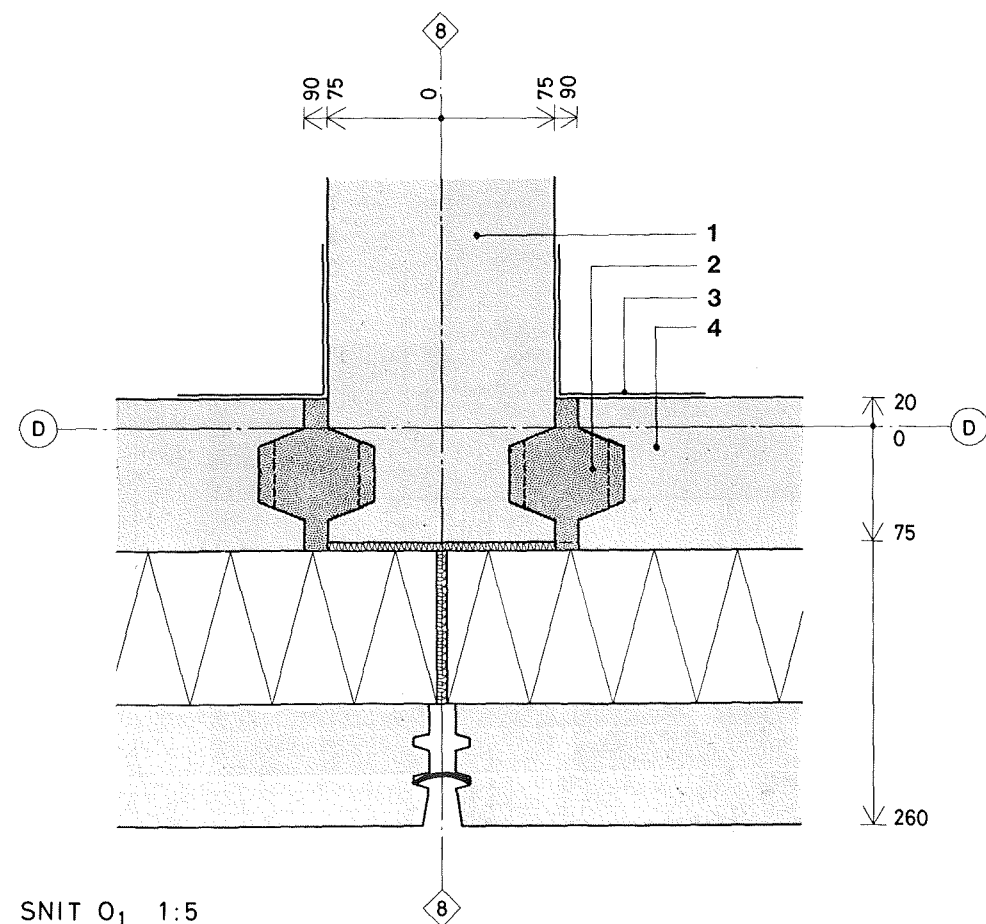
viser lodret snit i samlingen mellem dæk og den bærende gavl udført som betonsandwichvæg.
